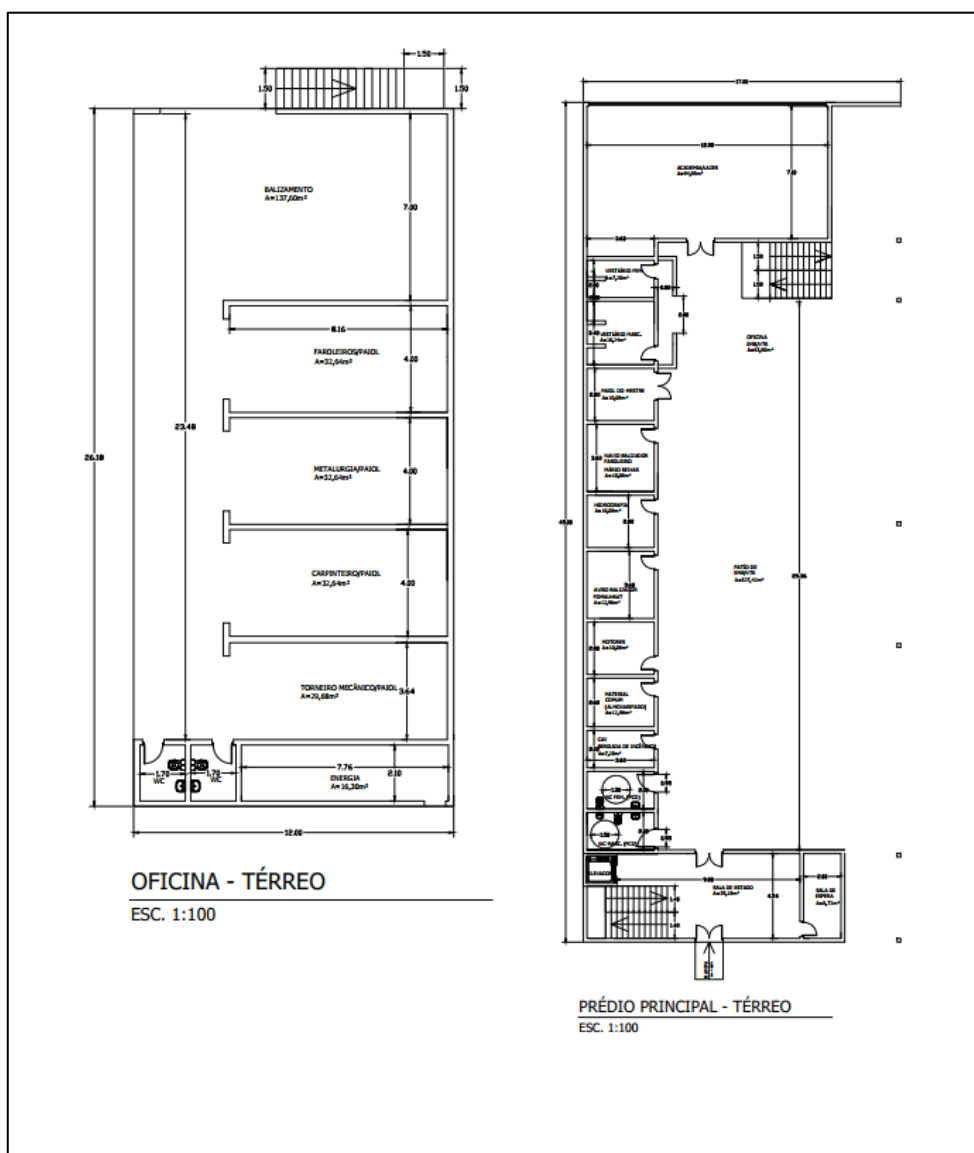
Imagem esquemática do conceito planejado para as edificações da nova sede do SSN8
